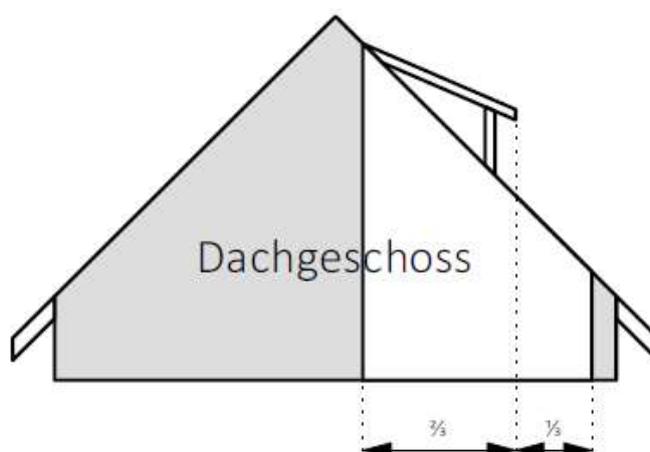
Skizze überdeckte Dacheinschnitte, PLANAR 2022
